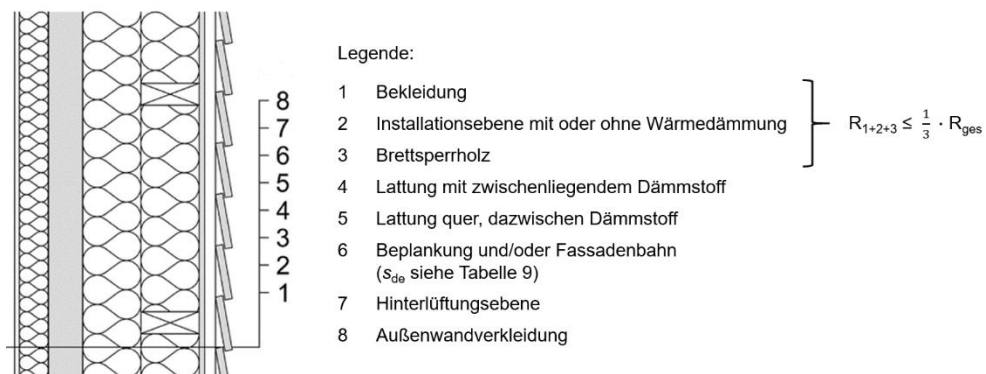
Außenwand in Holzmassivbauweise mit innerer und äußerer Wärmedämmschichte geändert nach [1].
